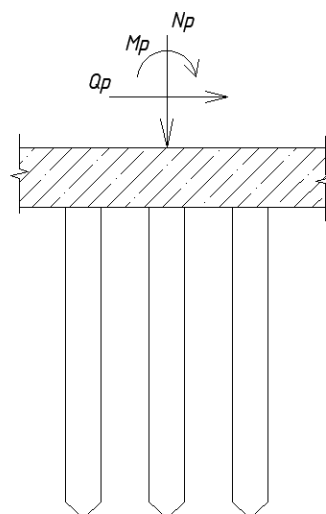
Схема приложения нагрузок на ростверк
